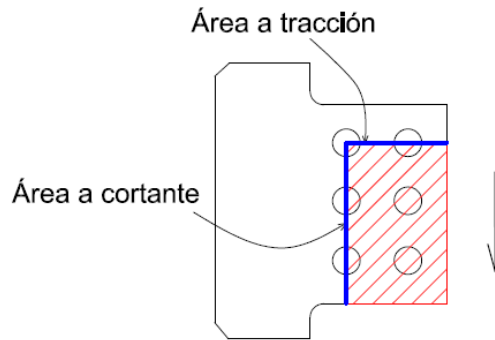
Bloque de corte en plancha PL1 por carga cortante-forma en L
